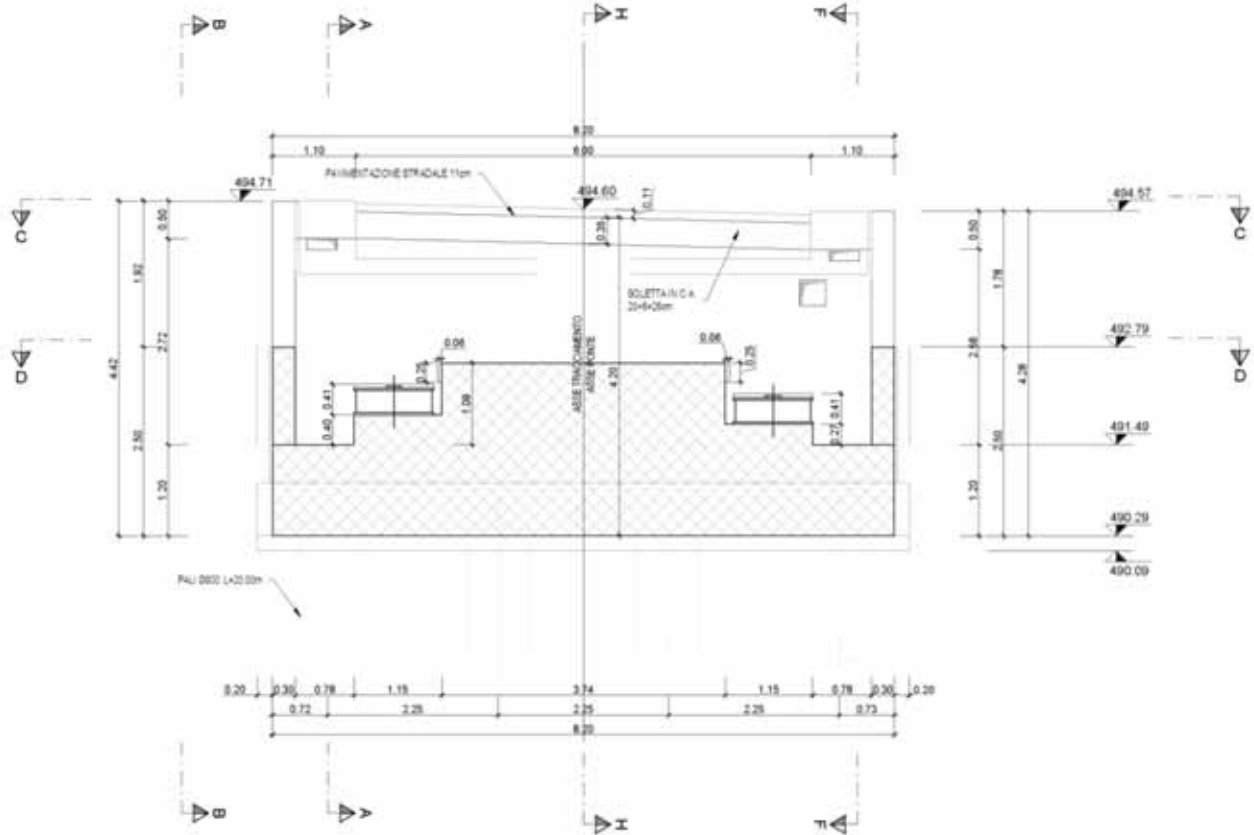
SPALLA B – Sezione longitudinale
